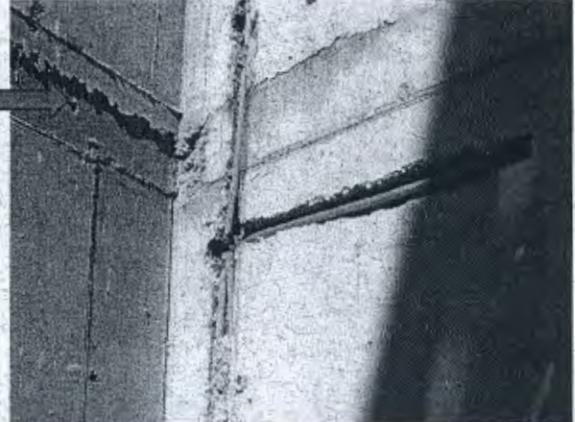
Hormigón picado en muro del subterráneo del módulo 10.
